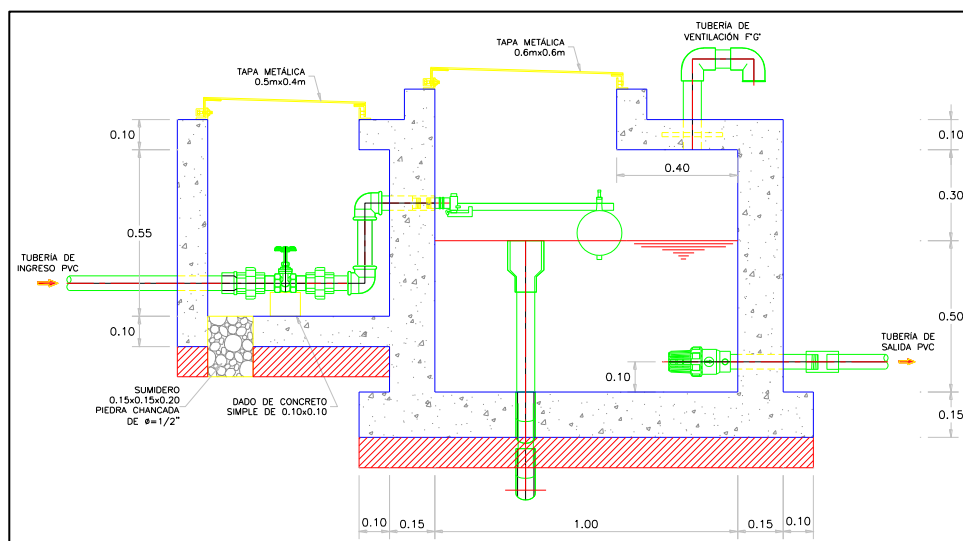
Vista de Elevación de la Cámara Rompe Presión Tipo 7 Proyectada
